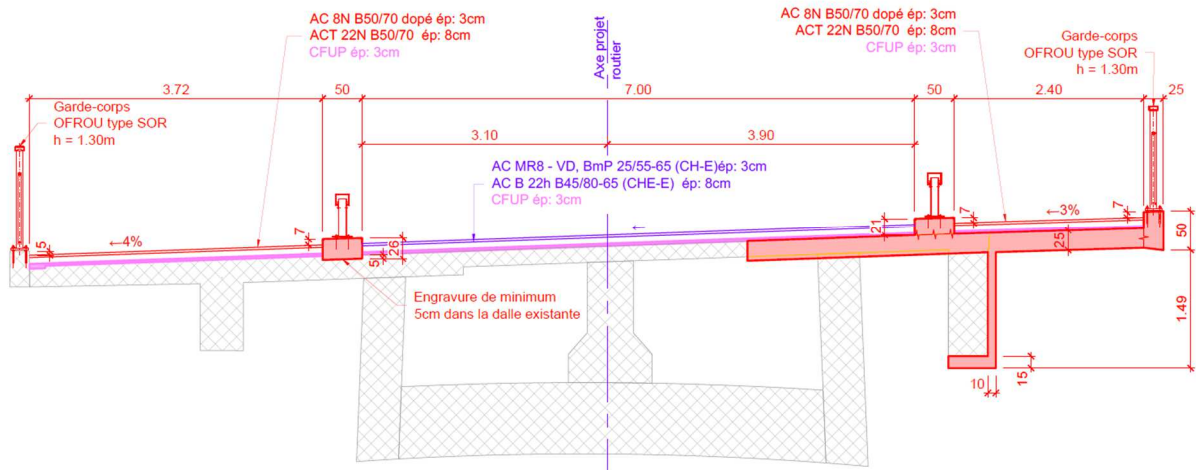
Coupe-type au droit du pont sur la Promenthouse (sur la voûte)
